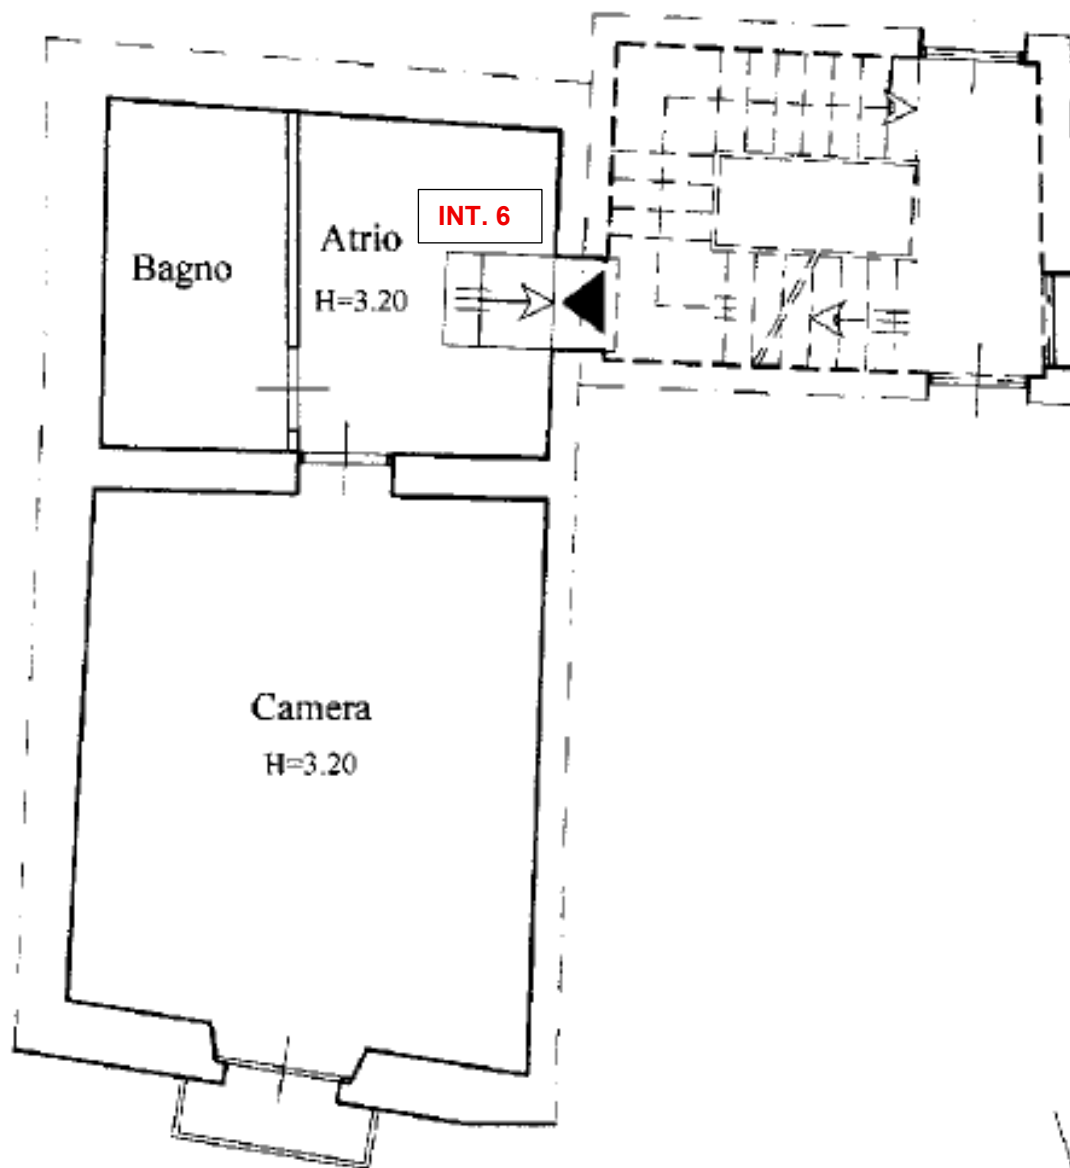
Lotto 2, stralcio della planimetria catastale in atti del secondo piano (fuori scala)
